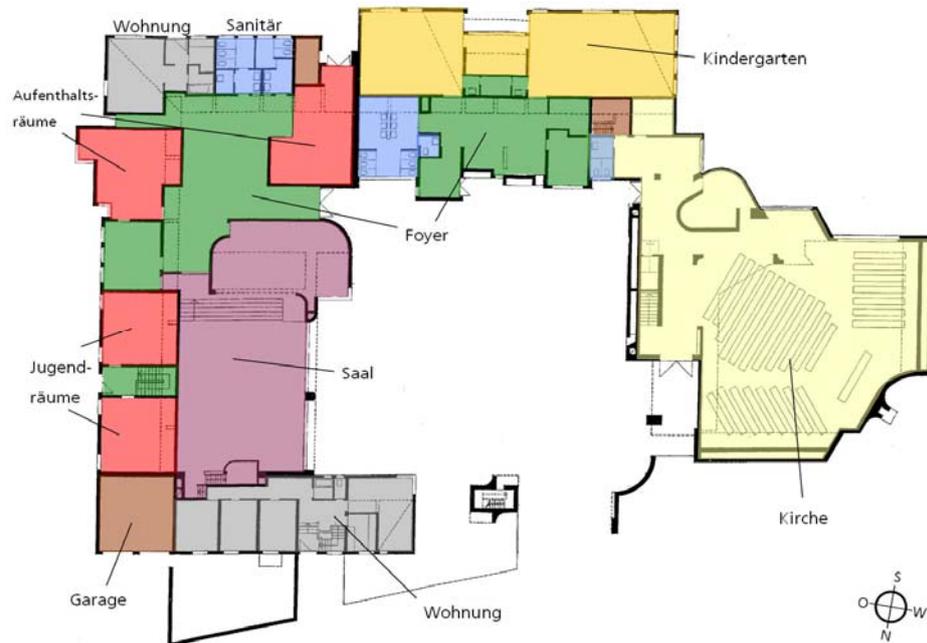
Grundriss des Gemeindezentrums in Stuttgart mit Angabe der unterschiedlichen Nutzungszonen.
